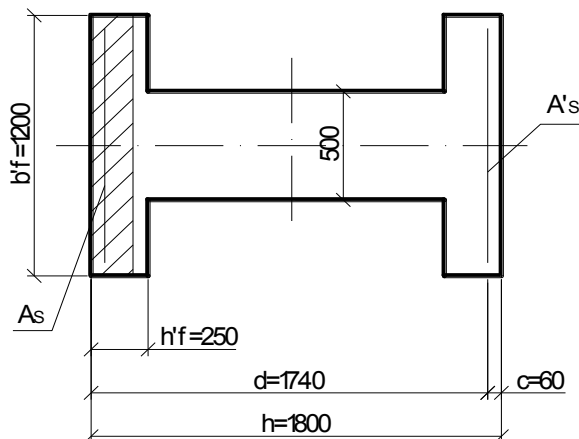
Расчетное сечение стаканной части фундамента
